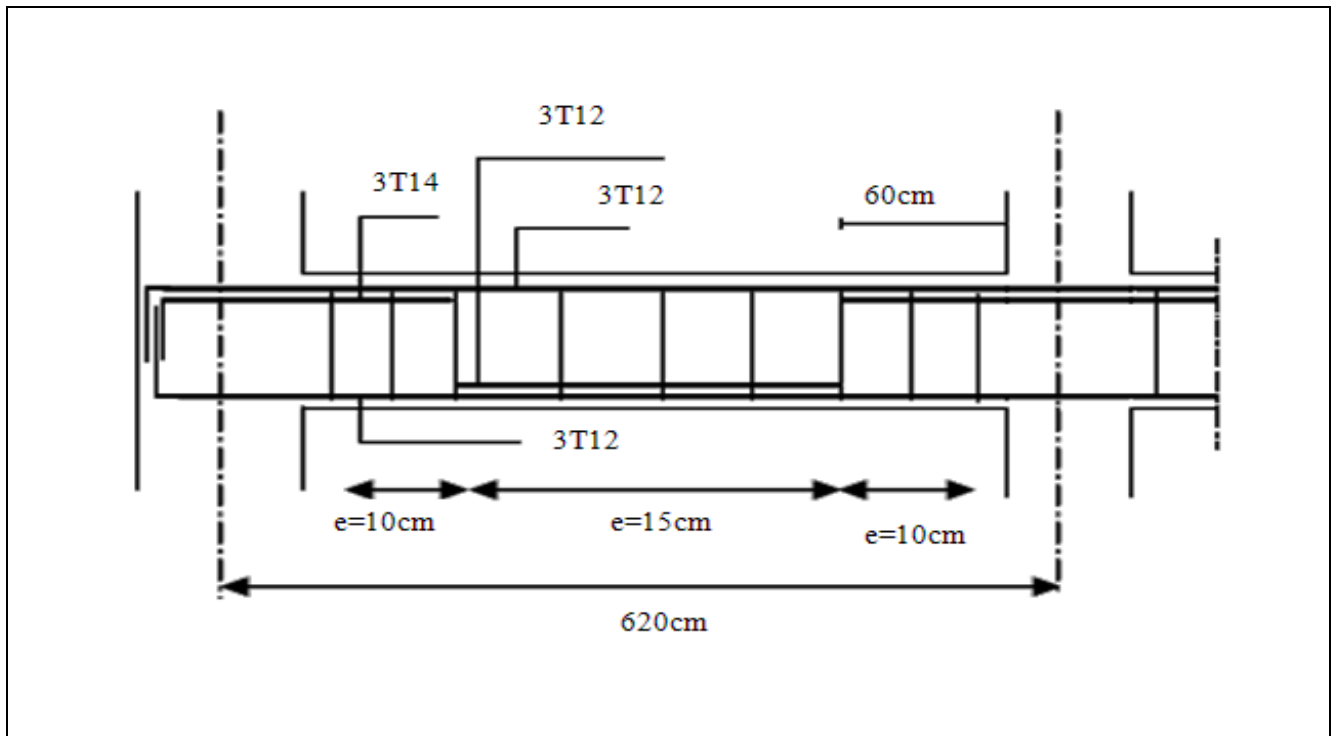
Disposition constructive de la poutre principale sous sol, RDC et 1^{er} étage
